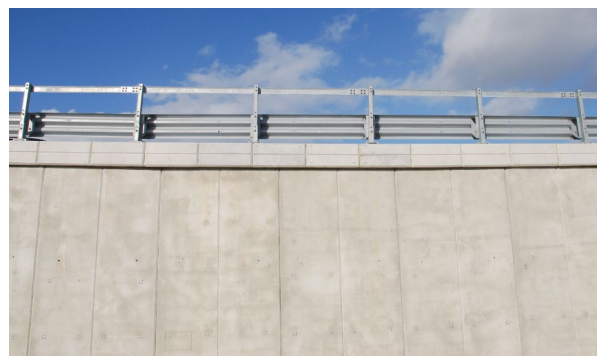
Viga de coronación en muros prefabricados con módulos de 1.10 m de anchura.
